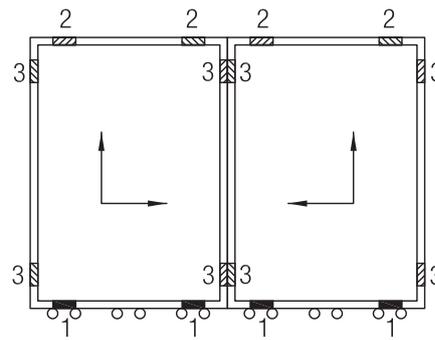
Horizontal-Schiebe-Element mit je 3 Laufwägen pro Flügel
